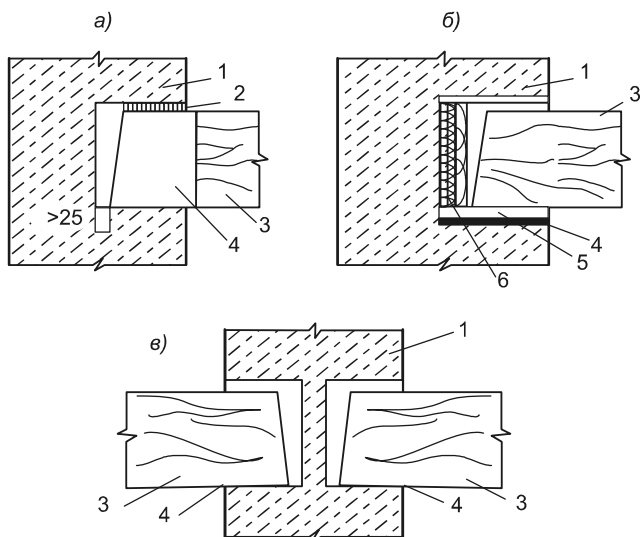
Схемы узлов опирания деревянных балок на стены:
